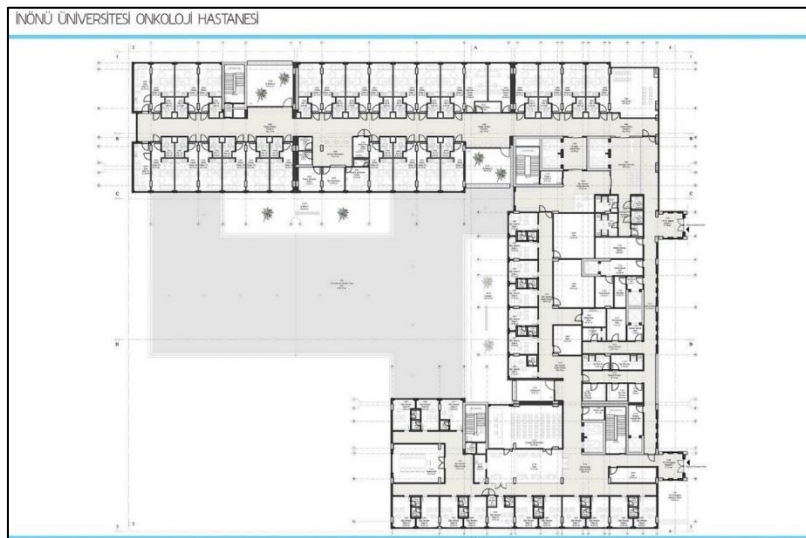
Hastane üçüncü kat planı. ölçek :1/300 (URL15).
